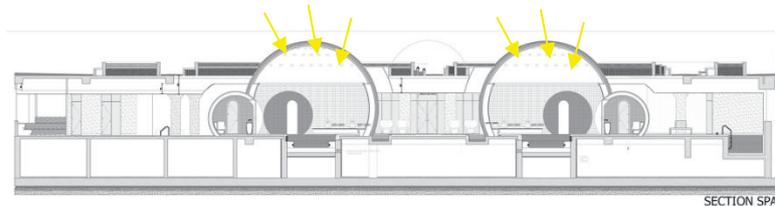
coupe spa <https://www.archdaily.com/523257/eskisehir-hotel-and-spa-gad-architecture> traite par l'auteur
